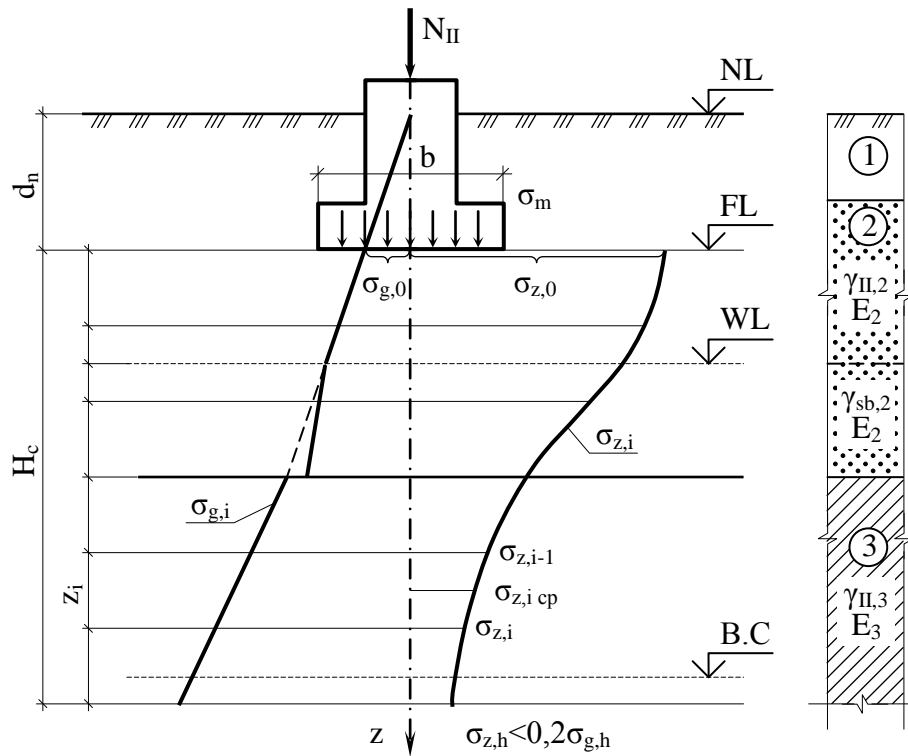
Схема до розрахунку осідань методом пошарового підсумування
